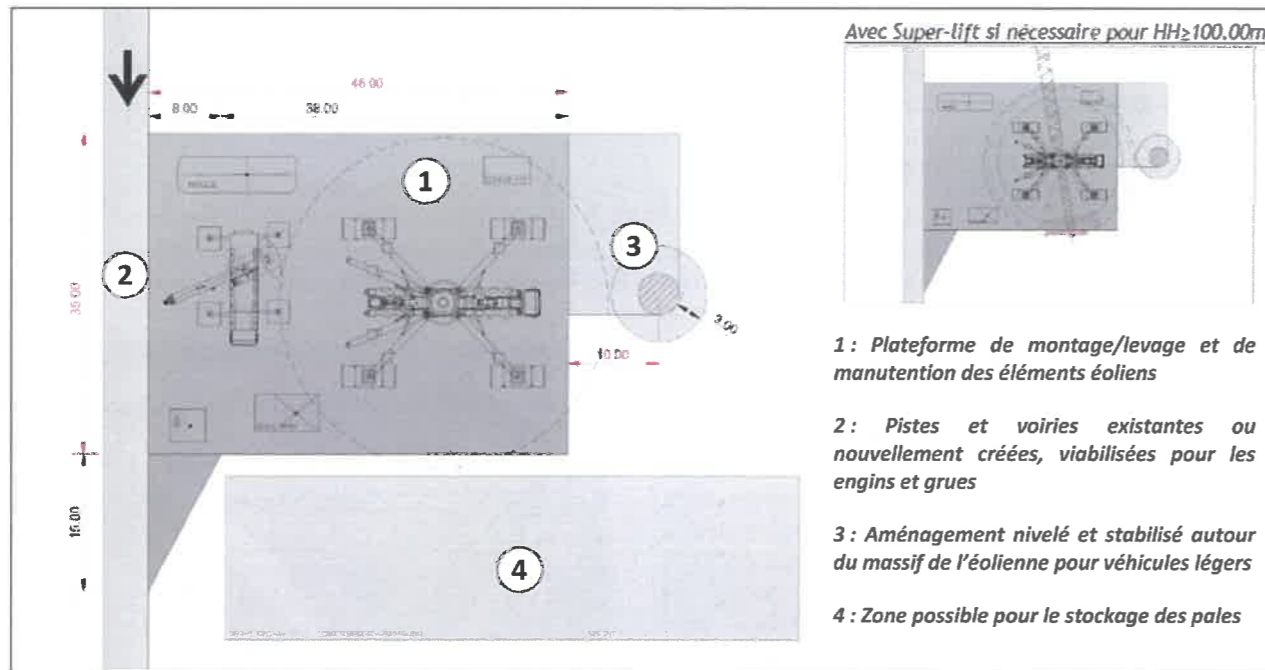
Plan type d'une zone de travaux aménagés pour le montage d'une éolienne VESTAS (VESTAS)
